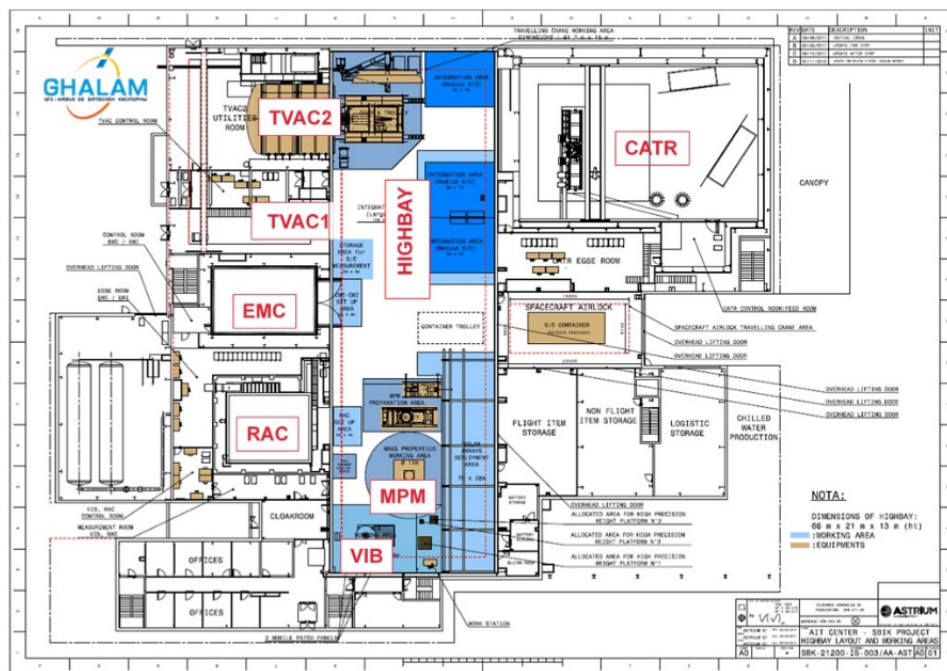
Сборочно-испытательный комплекс КА
